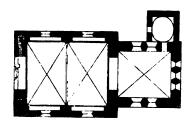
Vorland, Kirche. Grundriss. 1 667.
